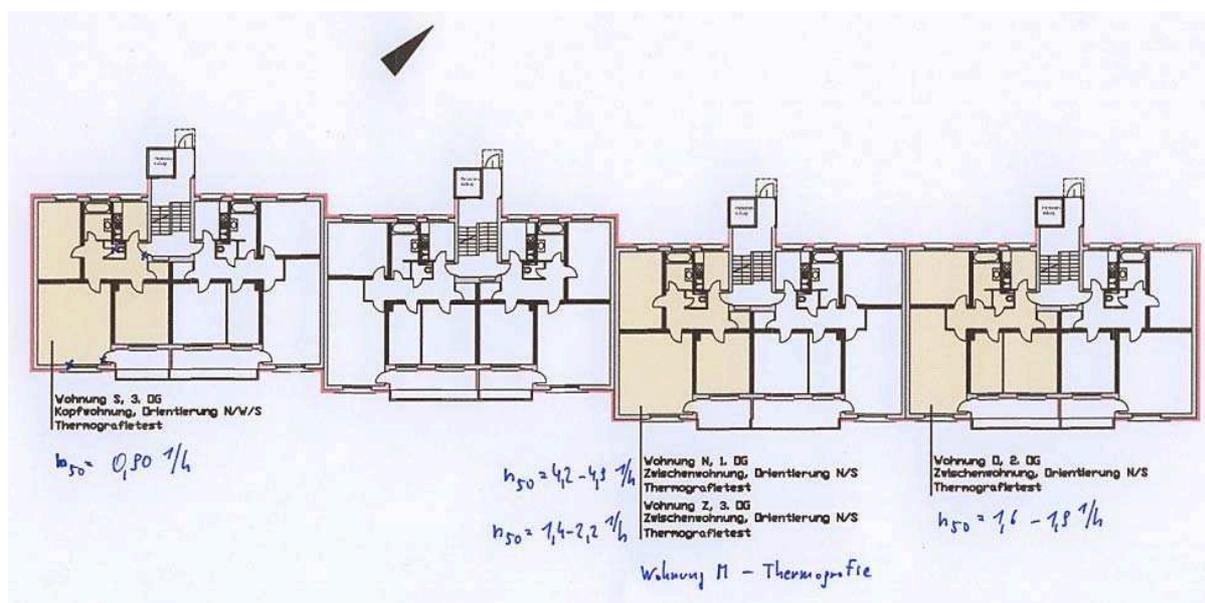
Grundriss Lage der Wohnungen, die mit Blower-Door-Test geprüft wurden.
